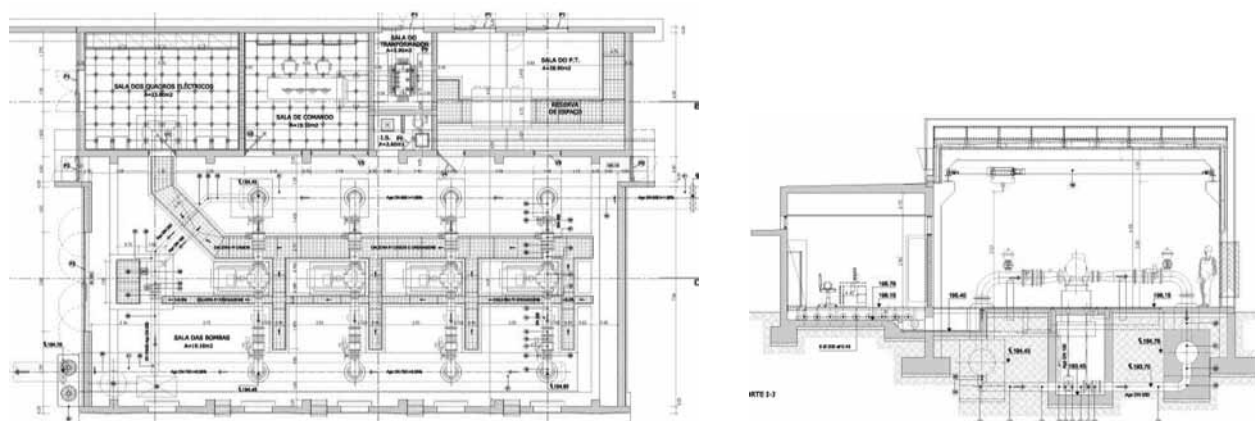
Estação Elevatória de Beringel. Planta e Corte
